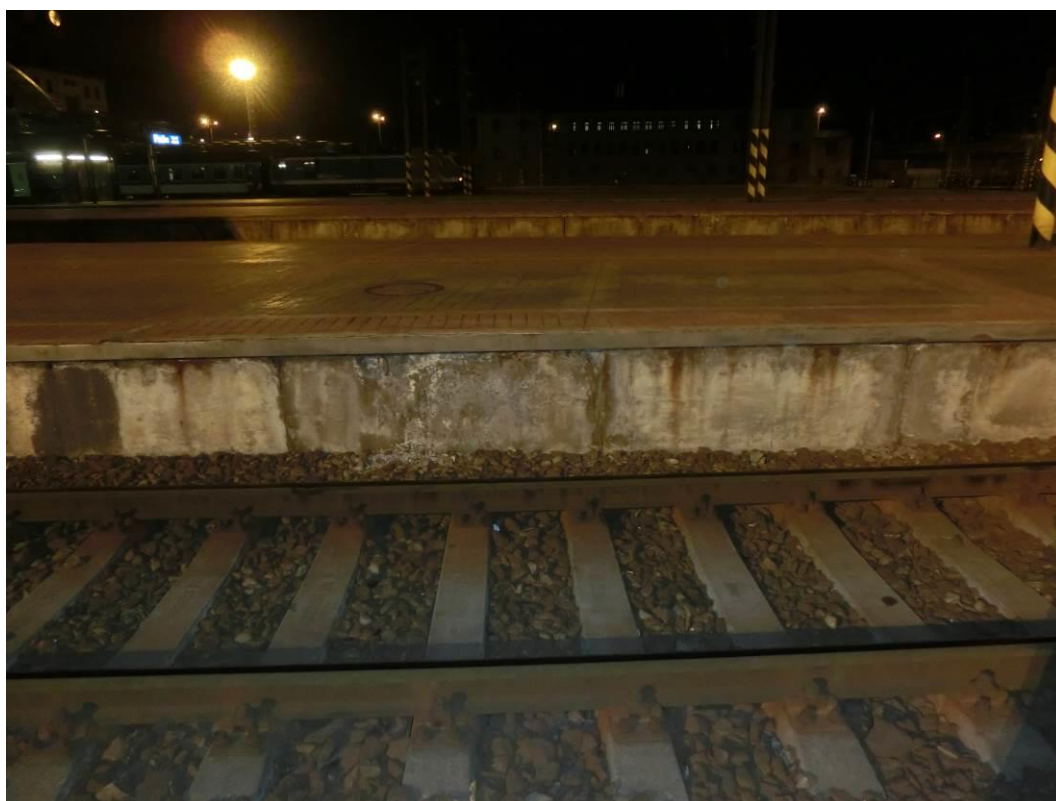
Pohled na nástupištní zídku – patrná degradace krycí vrstvy betonu
